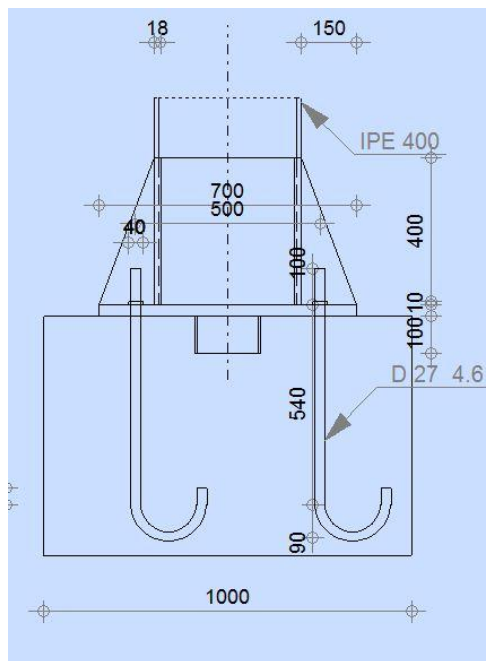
Vue du pied de poteau encastré de a 2ème variante
